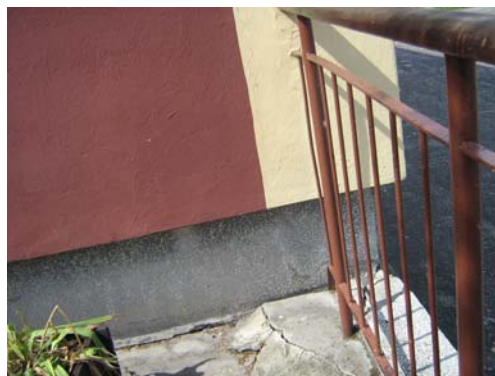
Sala gimnastyczna wschodnia z zapleczem (dobudówka) – ZSPiG w Krobi – elewacja wschodnia i północna
